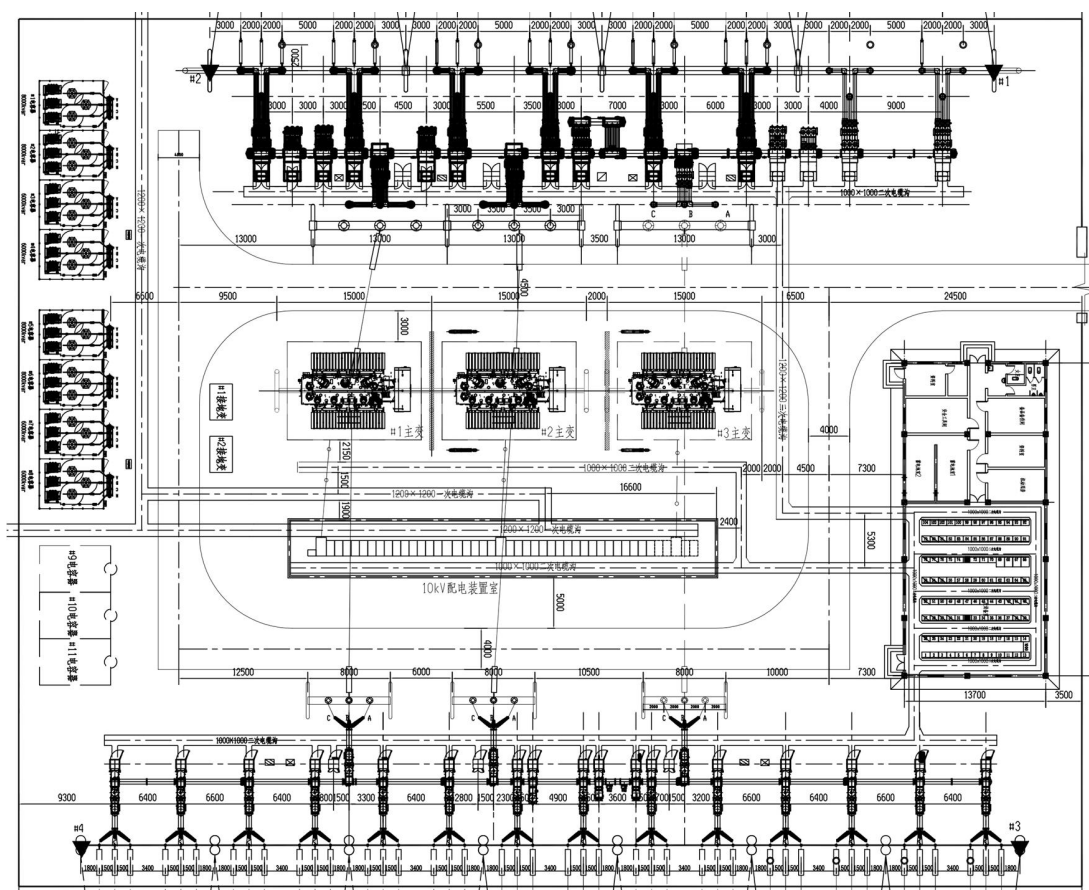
类比合肥 220kV 硕塘变电站中升压站平面布置示意图
